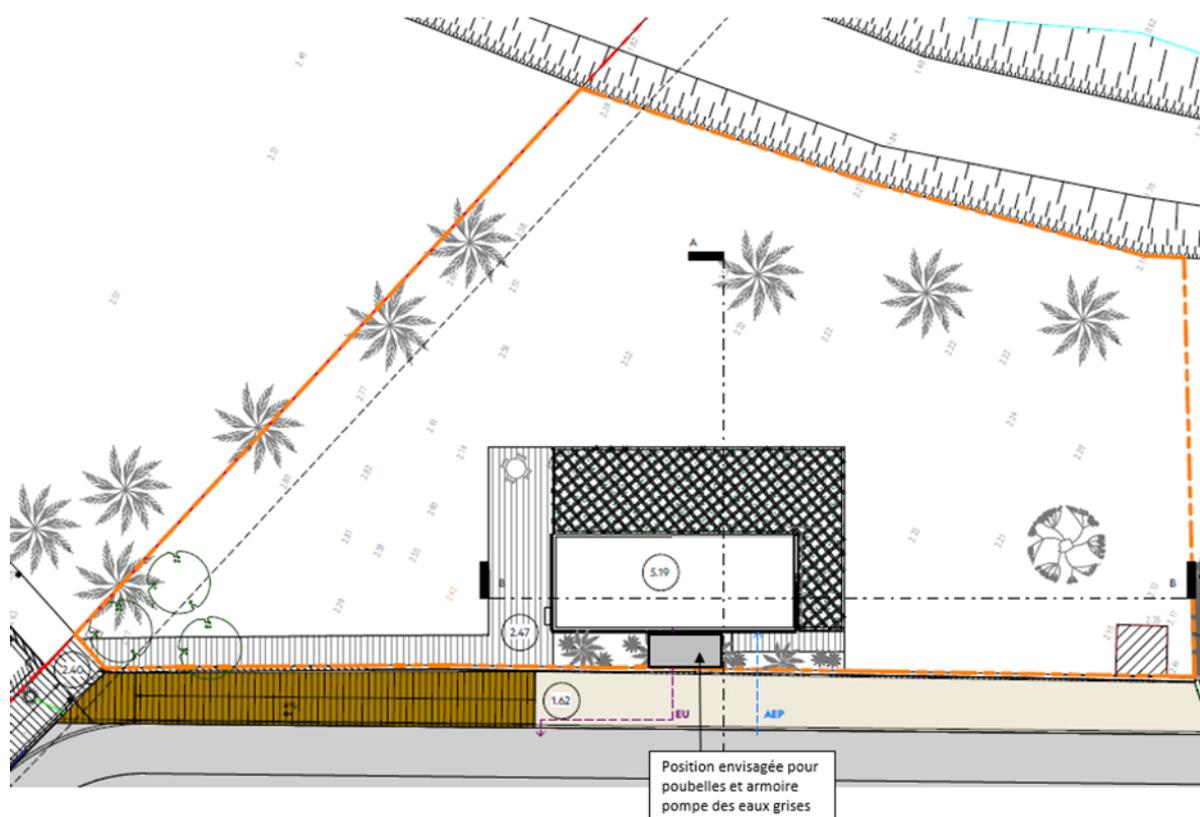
Plan de masse plus large du bâtiment chez Josy
